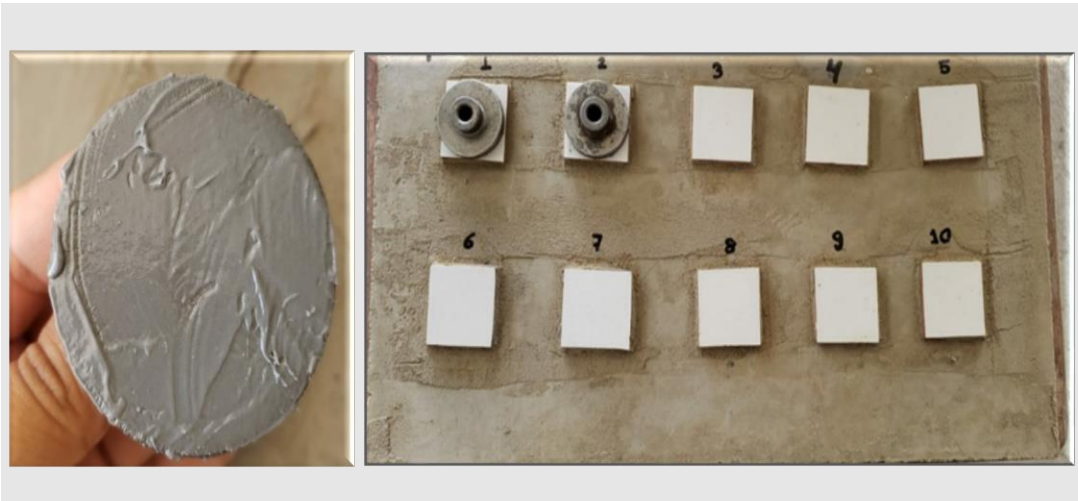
Aplicación del cemento cola tipo C1 elaborado en placas de cerámicas para prueba de adherencia inicial
